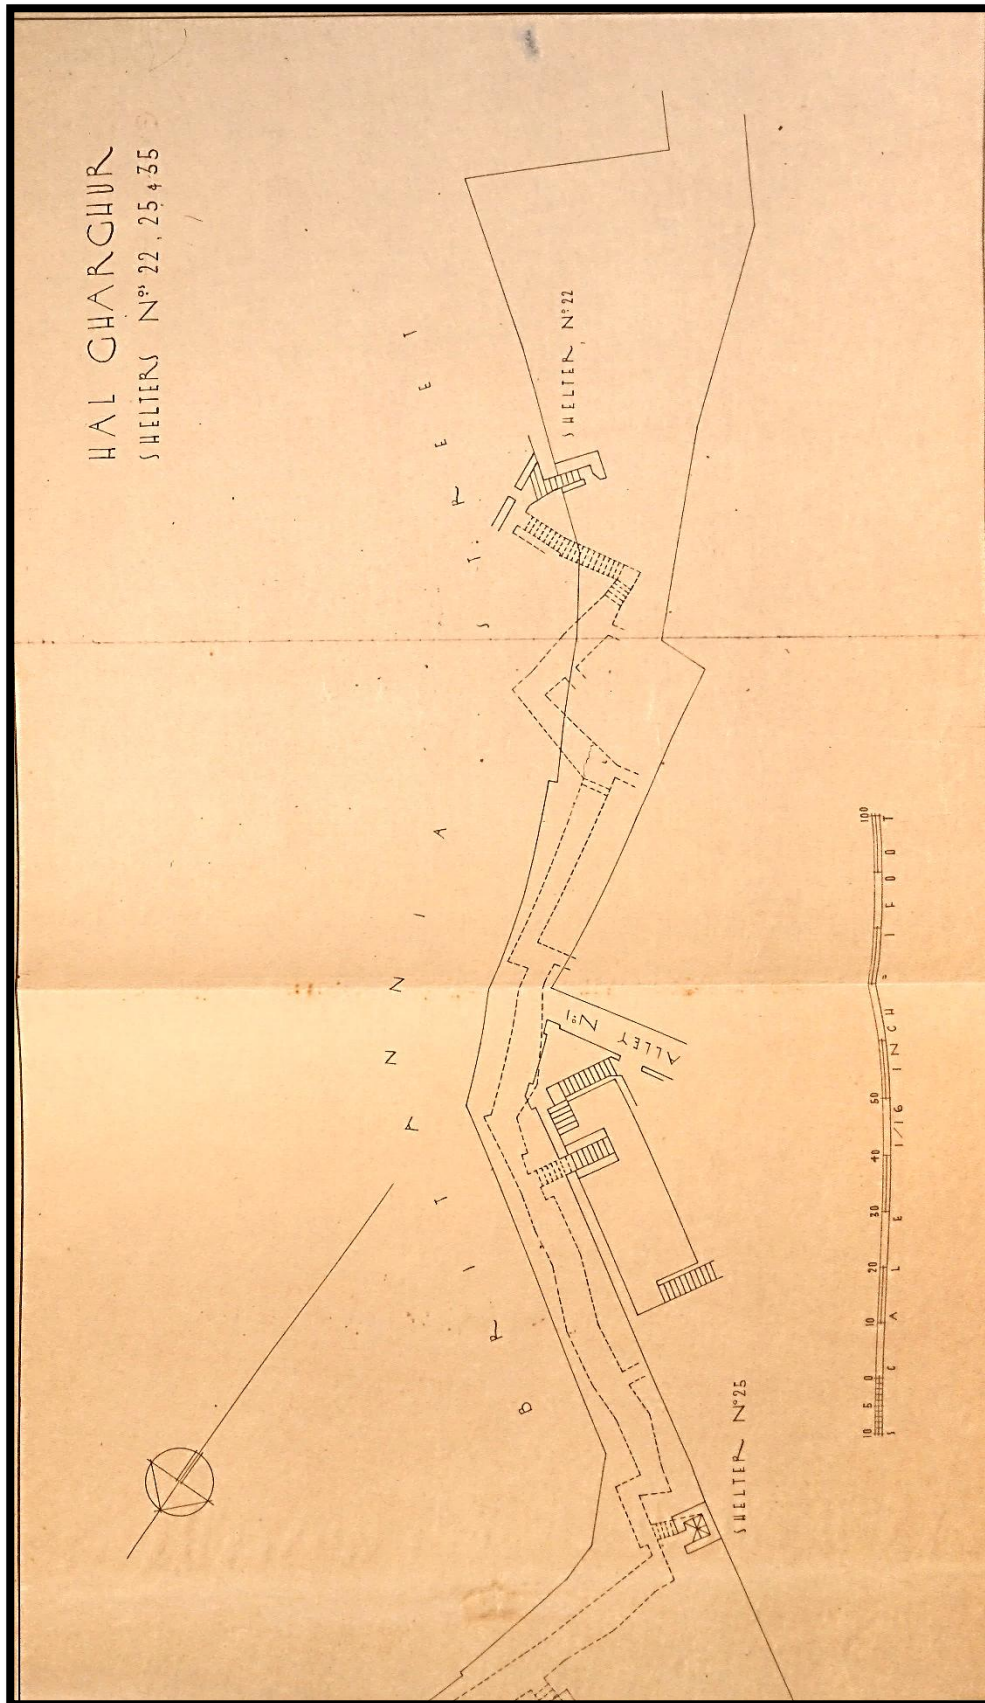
Planta dos Abrigos nº22, 25 e 35 (9) "Britannia Street"
